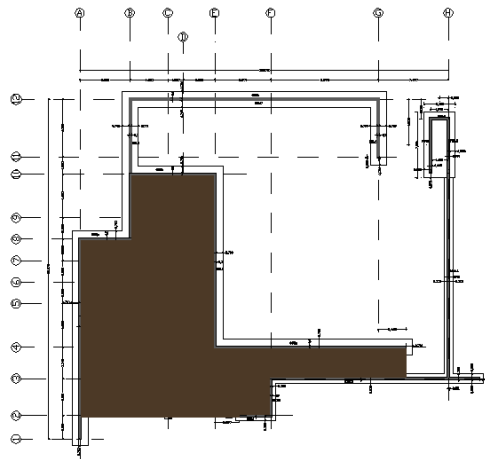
Área do piso 0 destinado à utilização de uma camada de massame (cor castanho)
